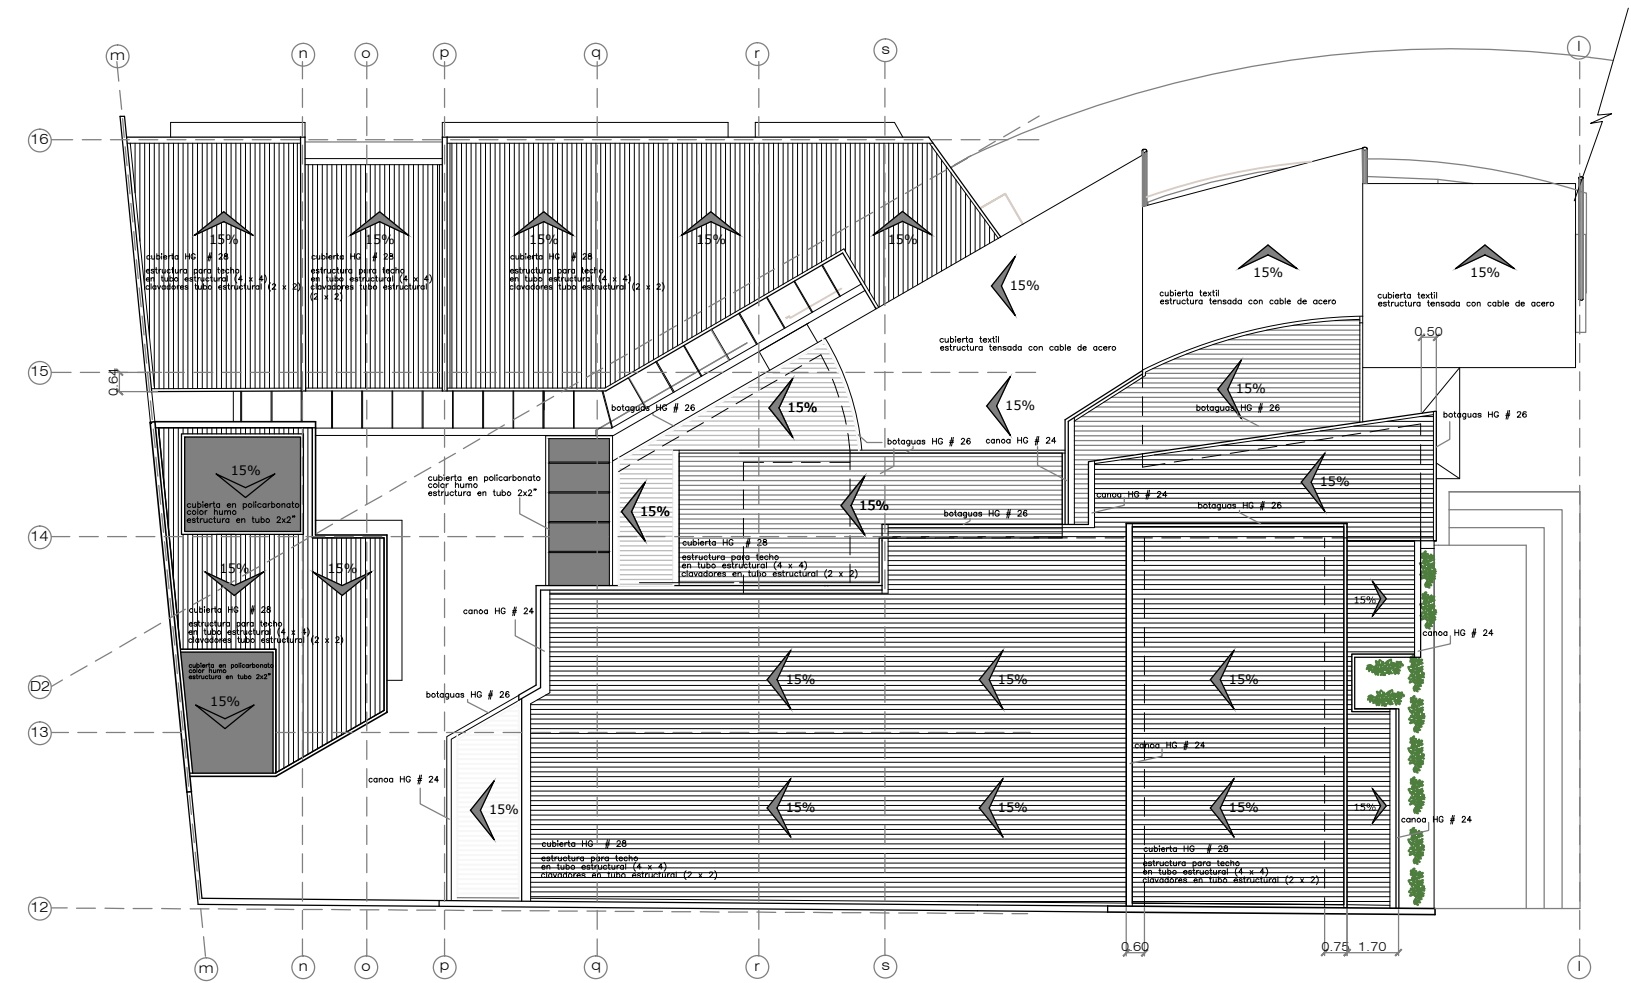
PLANTA CUBIERTAS-ETAPA 1+2+3
